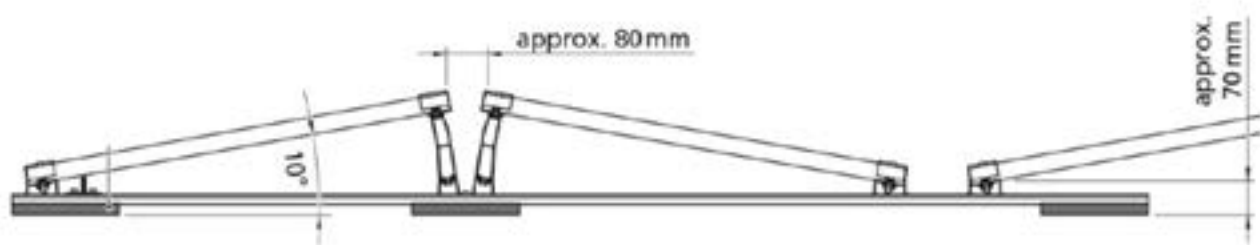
Estructura de montaje en dos orientaciones y 10° de inclinación para cubierta plana.
